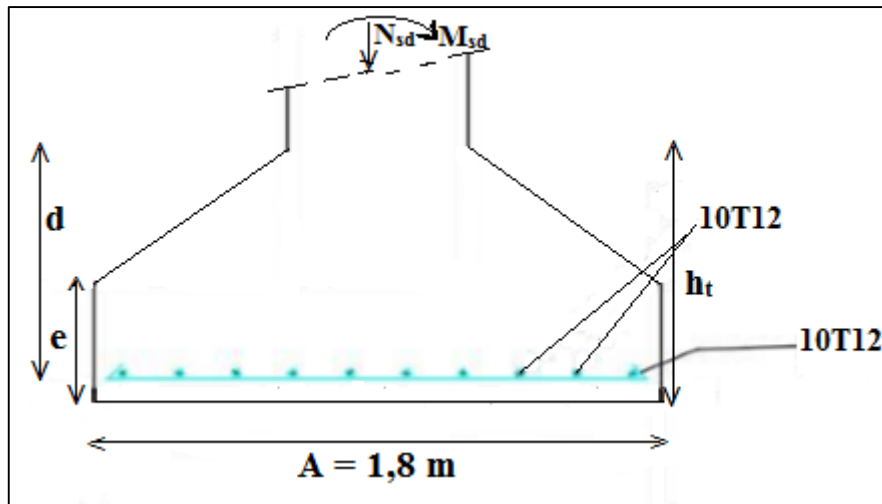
Vue du ferrailage des semelles isolées.
